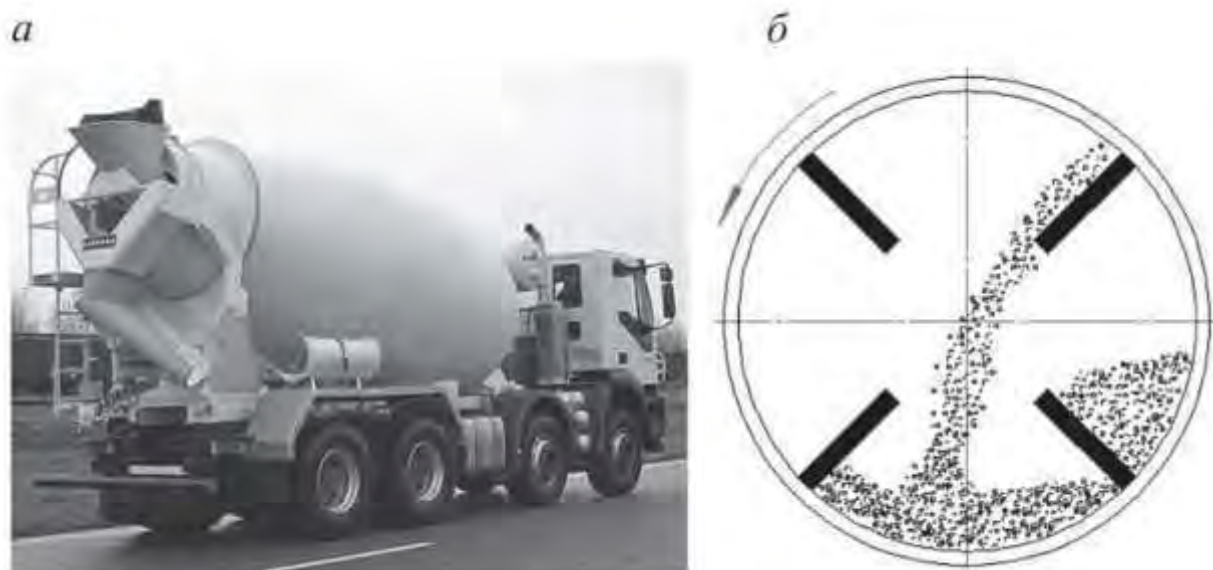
Передвижной смеситель (а) и схема перемешивания в нем бетонной смеси (б)
